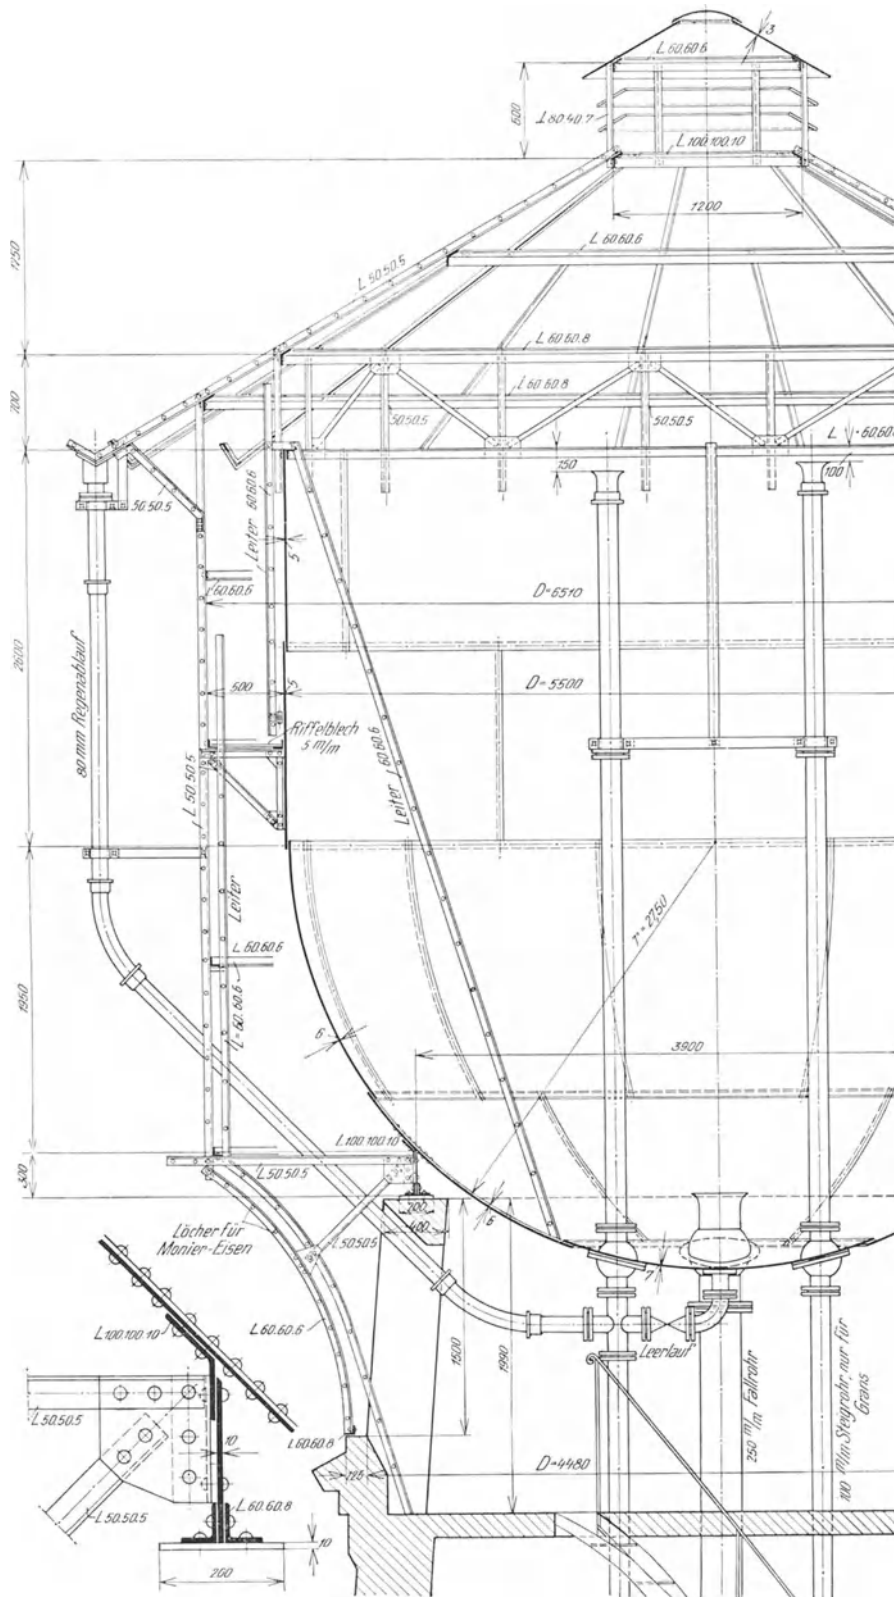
Wasserbehälter mit Halbkugelboden. (E. Wilke & Co., Braunschweig)
